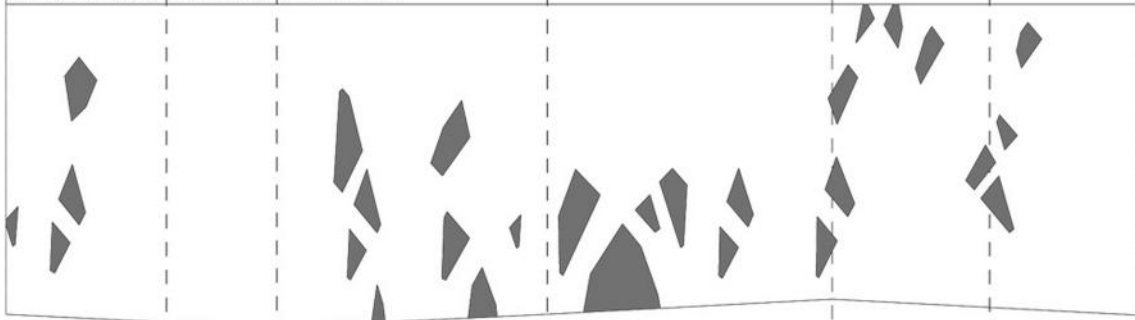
Detalles del armado del cerramiento estructural de hormigón.
